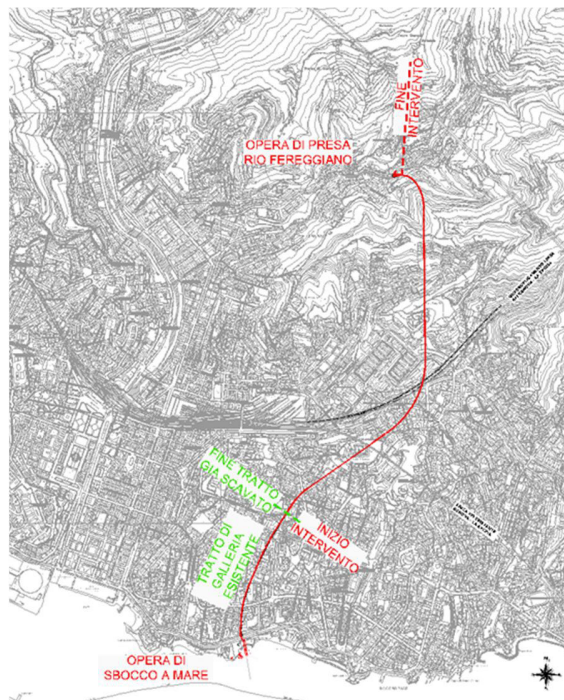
Individuazione delle opere di progetto 1° Lotto
